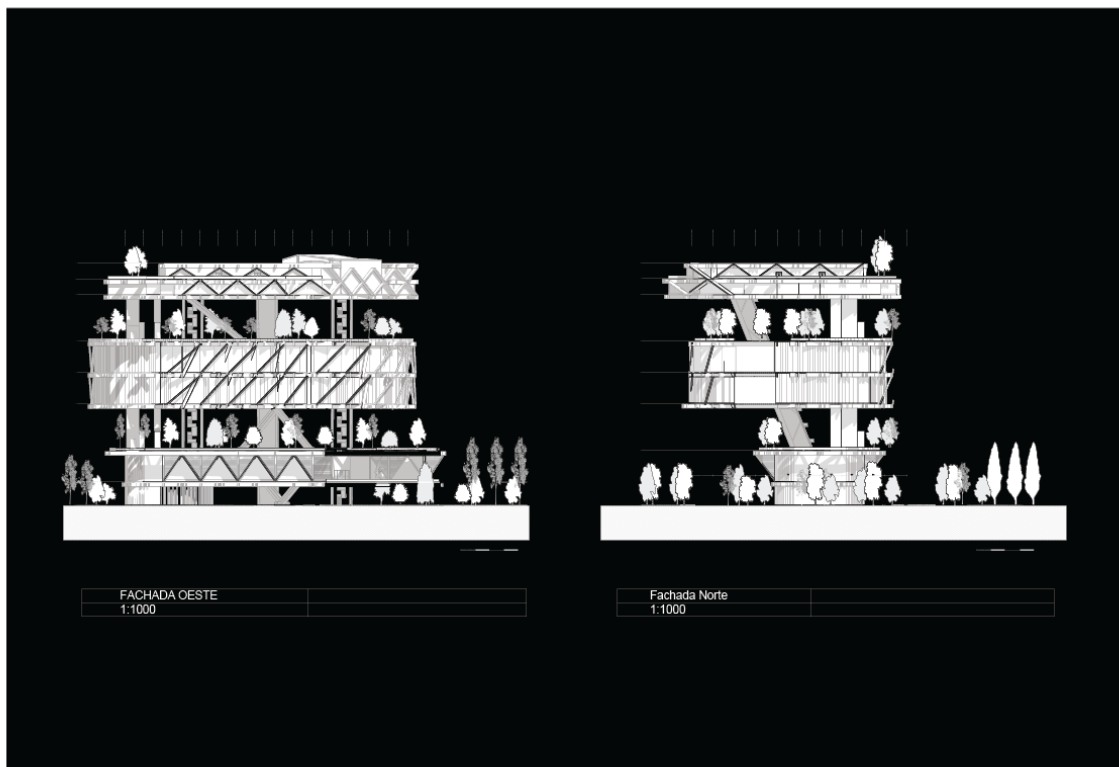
Fachadas Oeste & Norte, elaboración propia 2022
